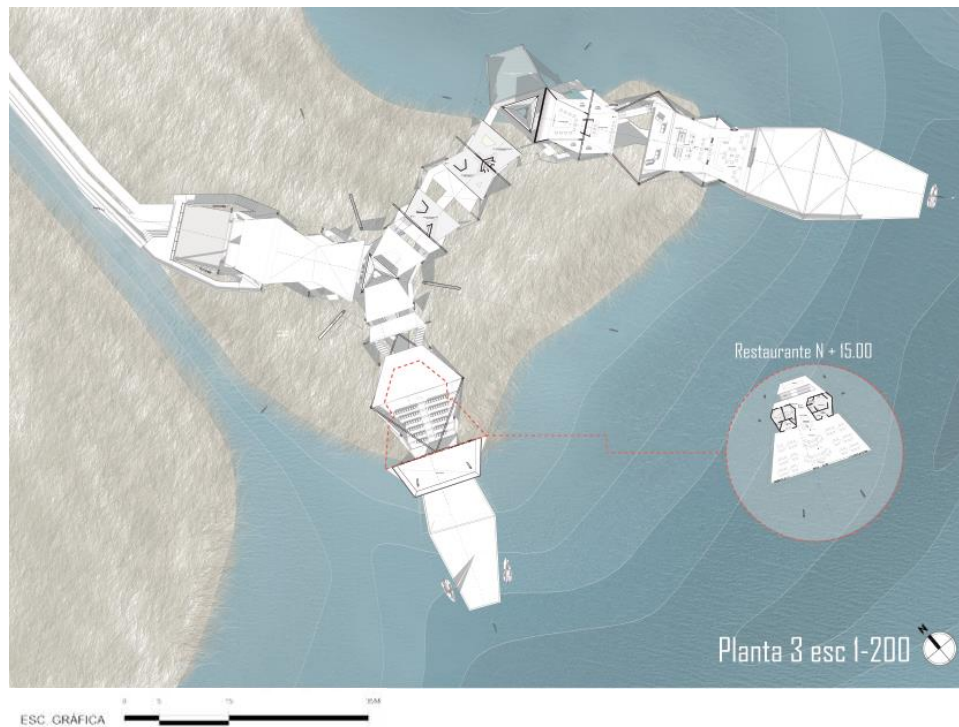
Planta arquitectónica tercer y cuarto nivel.
